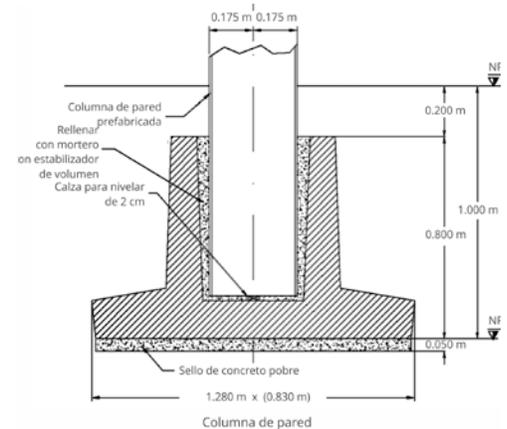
Detalle típico de fundación con placa prefabricada para nave industrial
